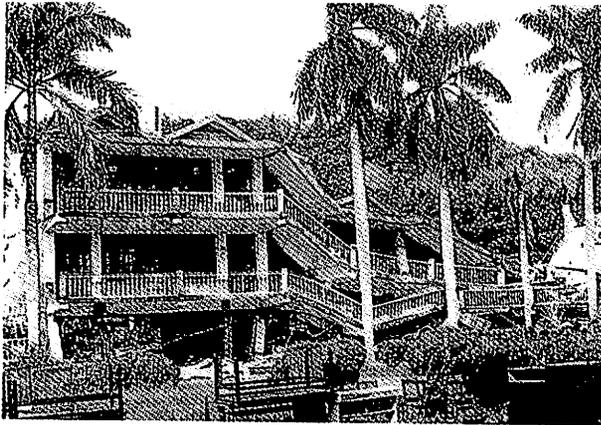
Photo 13, 14に隣接した中学校舎の崩壊
